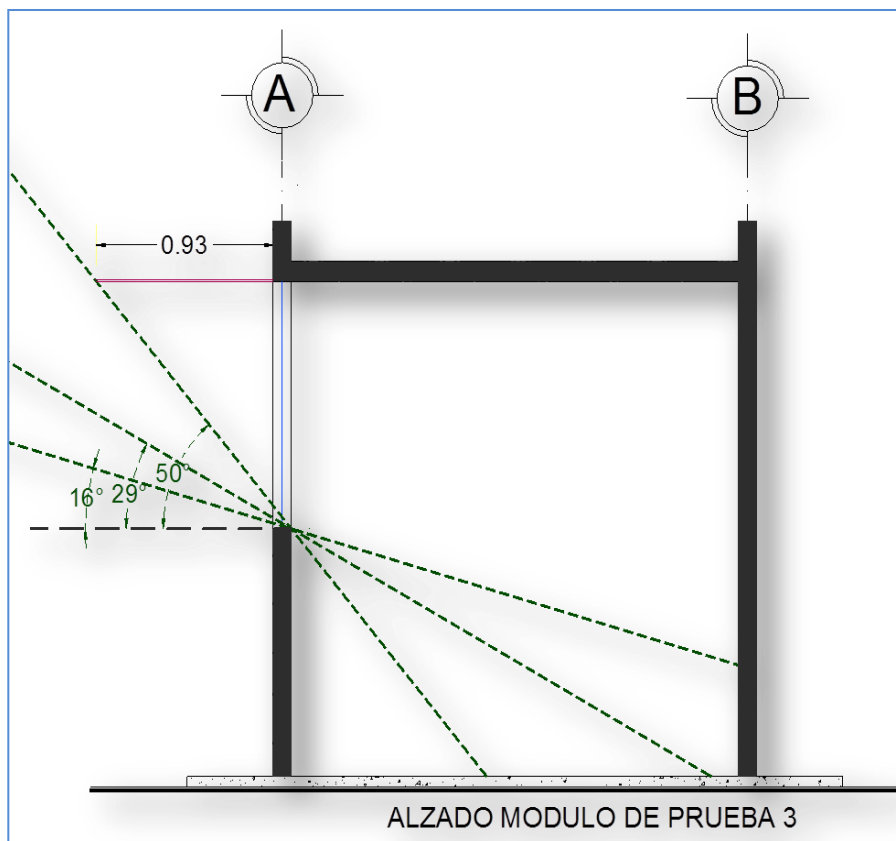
Proyección de ángulos en alzado en orientación oeste.
